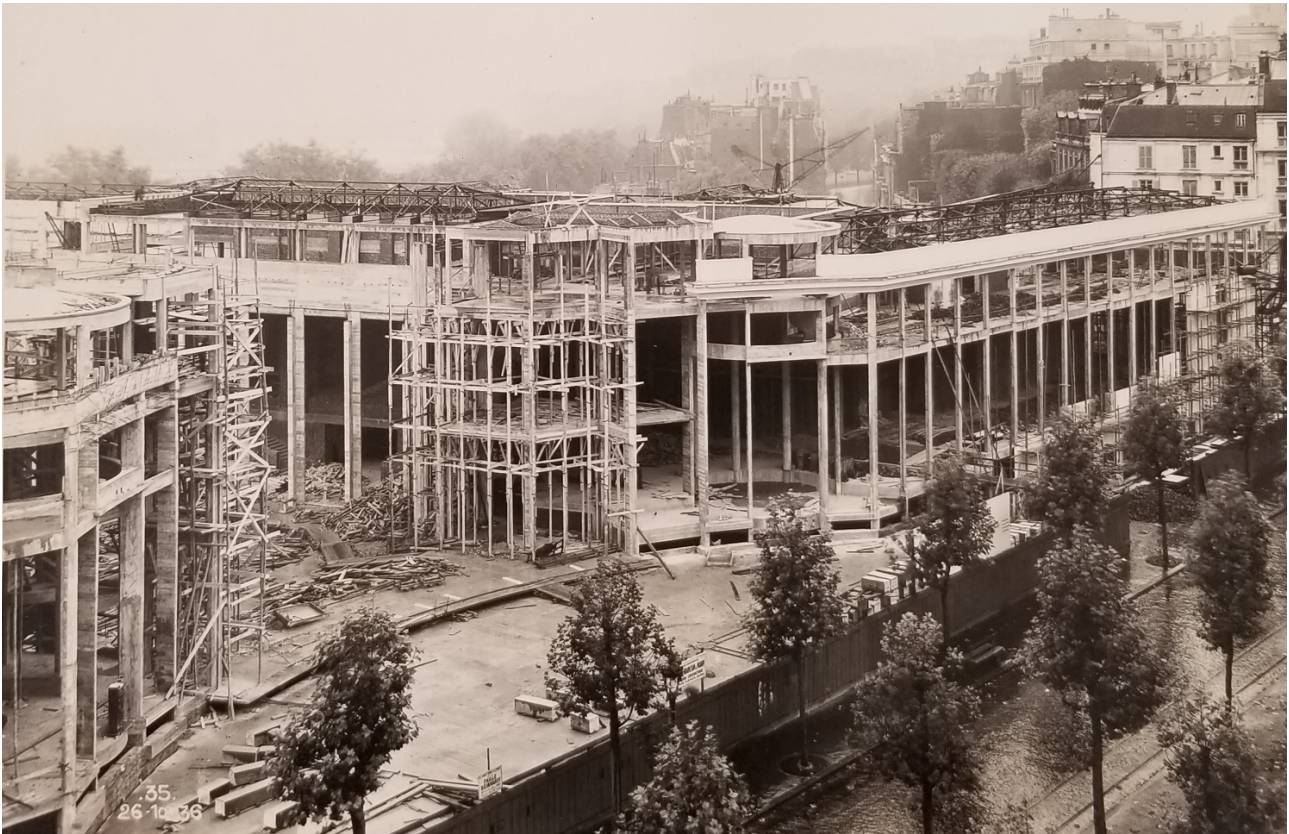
structure poteaux-poutres niveaux N2 et N3, autour de l'entrée principale (au niveau N3, rotonde attenante à la terrasse administration)
